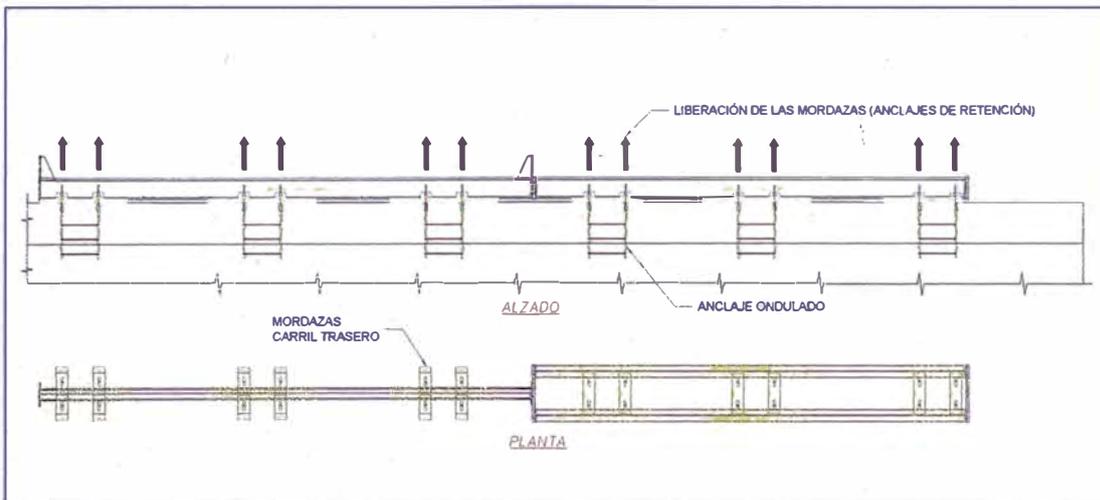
Vista elevación de retiro de anclajes de los carriles - Fuente: Elaboración Propia
